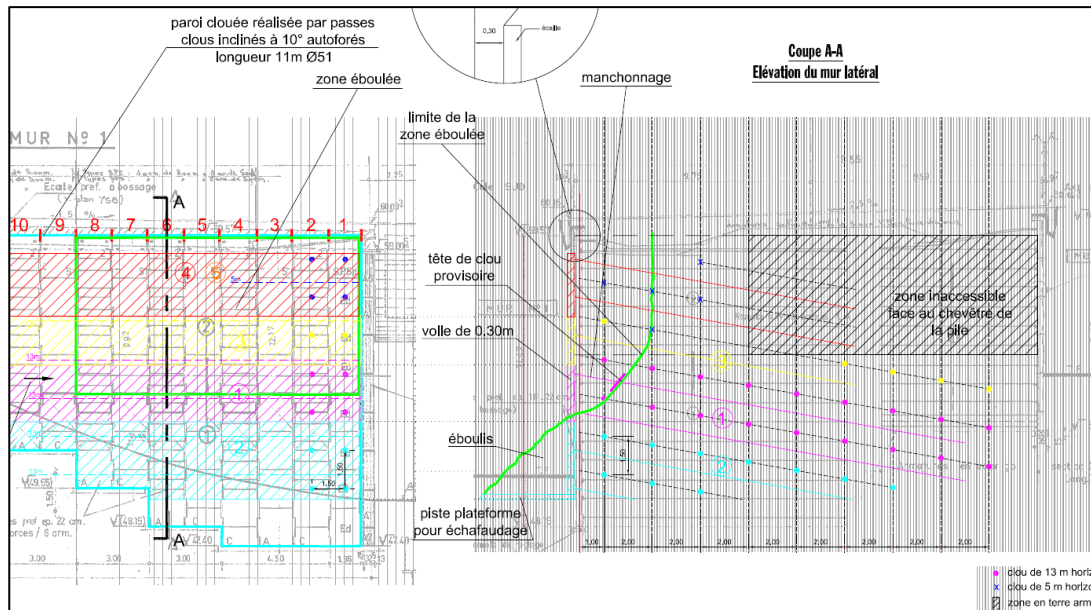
Plan du DCE précisant le renforcement de la zone effondrée
